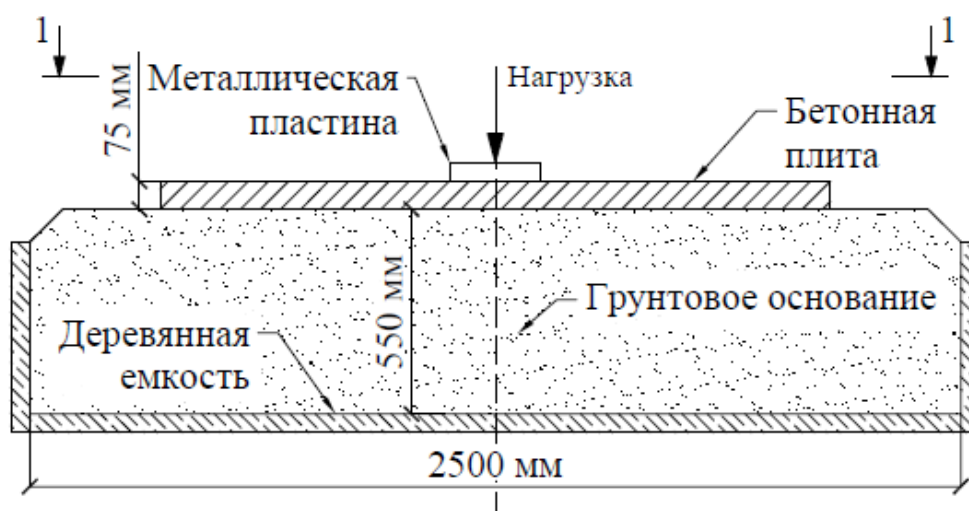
Схема нагружения плиты на грунтовом основании. Разрез.
